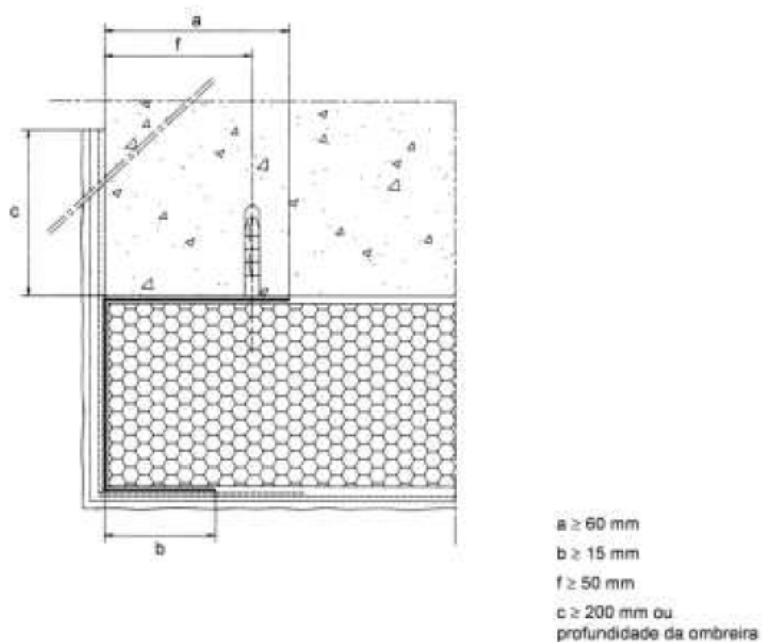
Aplicação do ETICS – Perfil de arranque do limite inferior do sistema [7]
